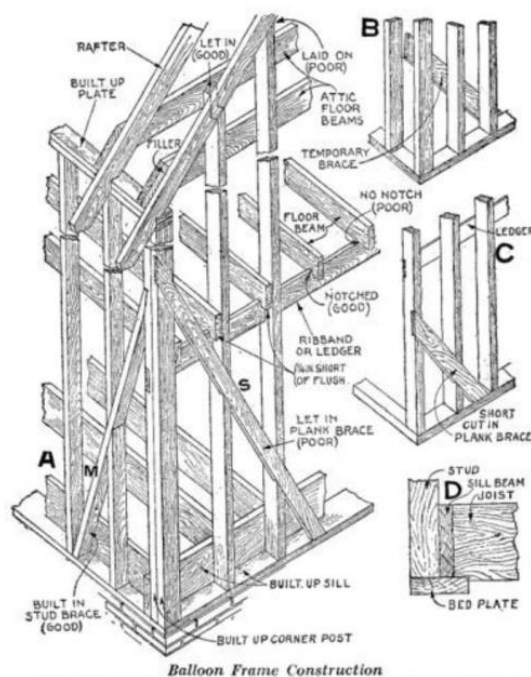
Entramado de madera (listones y tablas) para muros livianos durante los siglos XIX y XX tipo Balloon Framing. Fuente: Johnson, R. (2007) "The advantages of Balloon Framing." American Building Construction History. Consultado 15/08/2015. Recuperado de: <http://rljart.com/blog/wp-content/balloonframing.pdf>
